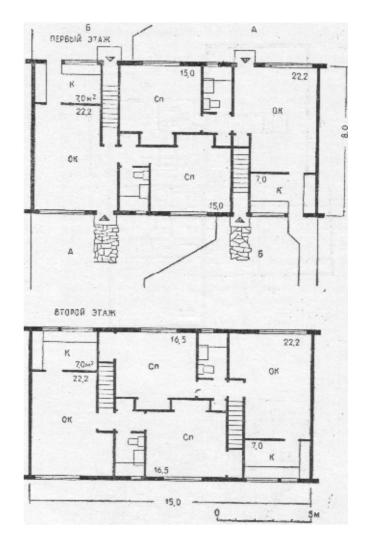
Поэтажные двухкомнатные квартиры блокированного дома (США) Жилая площадь квартиры 37,70 m^2 . Входы в квартиры с противоположных сторон. Планировка квартир сделана таким образом, чтобы непосредственно на участки квартир второго этажа выходили только окна кухонь квартир первого этажа которых может быть принята увеличенная высота подоконников. A — участок квартиры второго этажа
